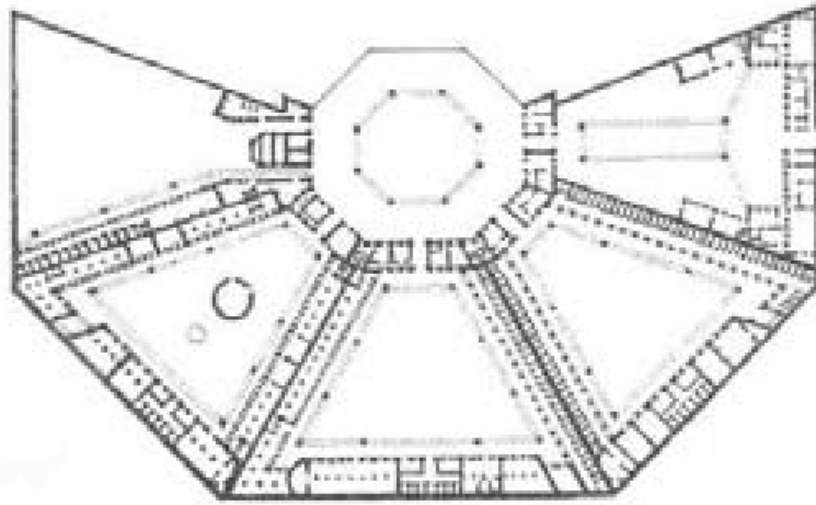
Planta do Maison de Force, Ackerghem. (Fonte: CHING, Francis D. K. 1998)
